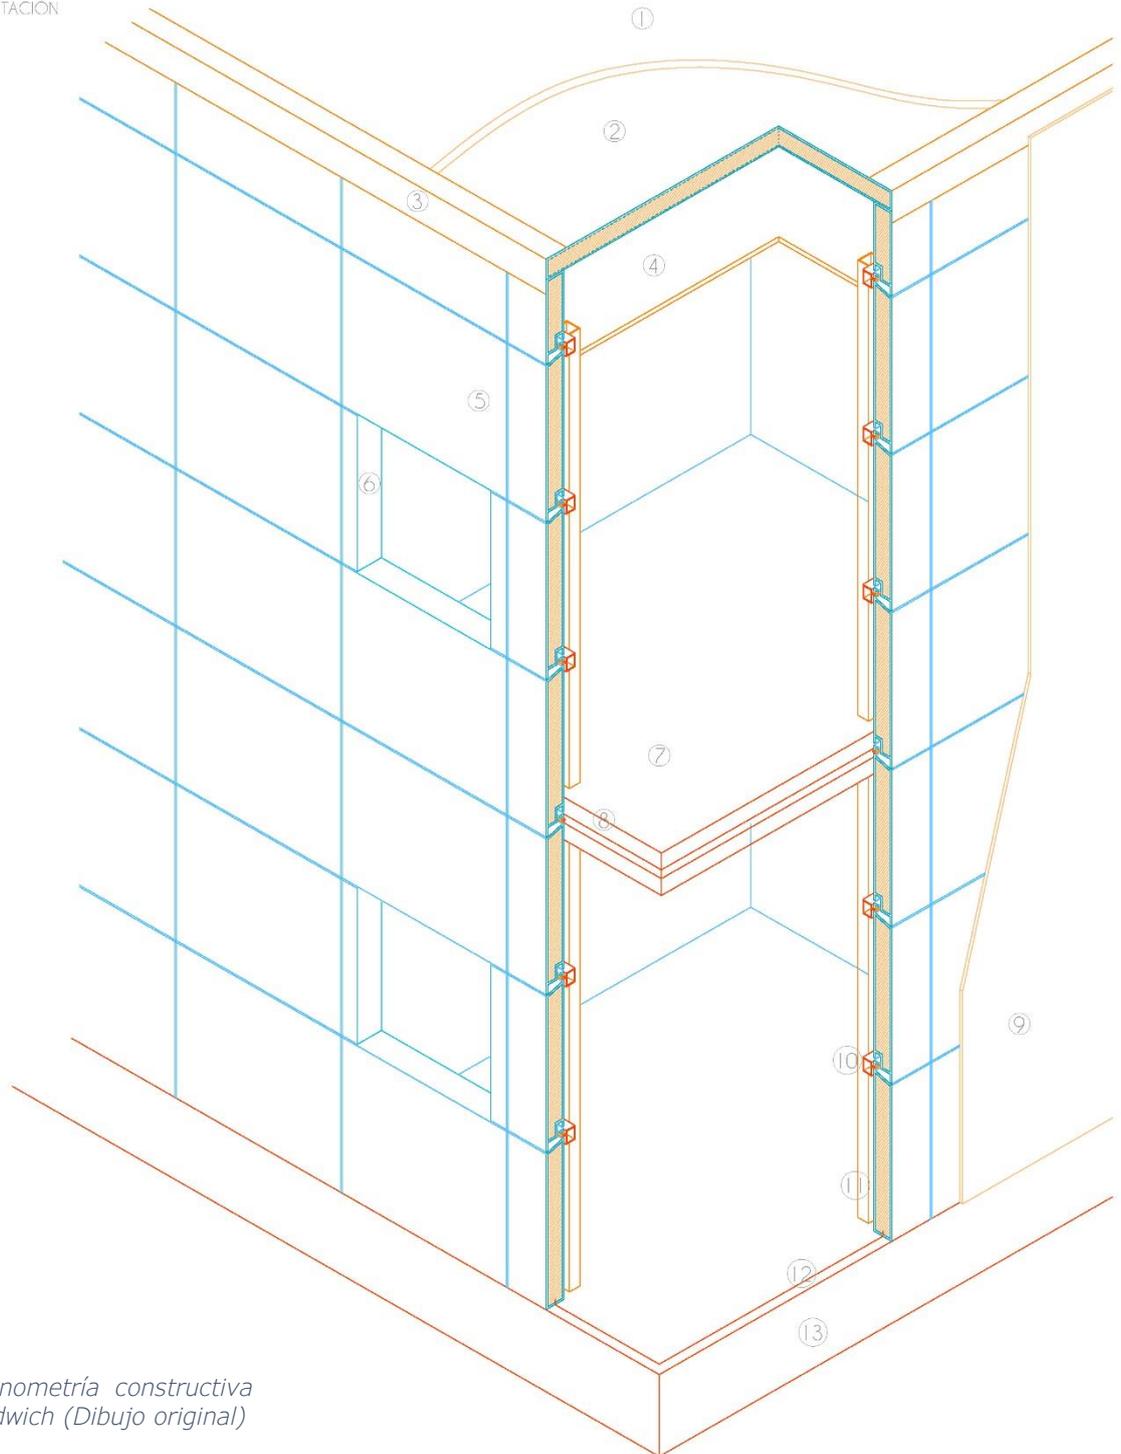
Axonometría constructiva de paneles Sándwich (Dibujo original)
